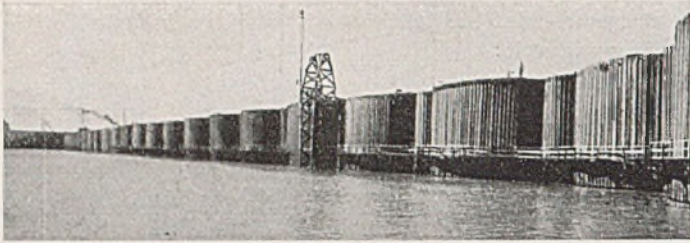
Zellen-Fangedamm für die Schleusen-grube.
